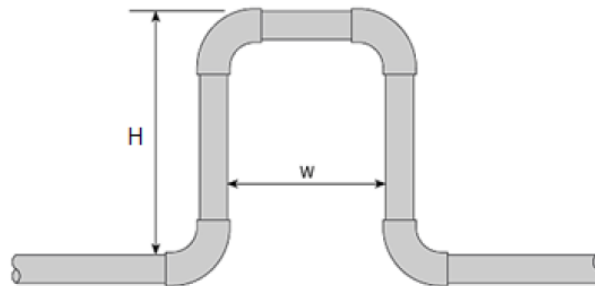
lazo de expansión (*expansion loops*). (Vidaurre, 2014)
